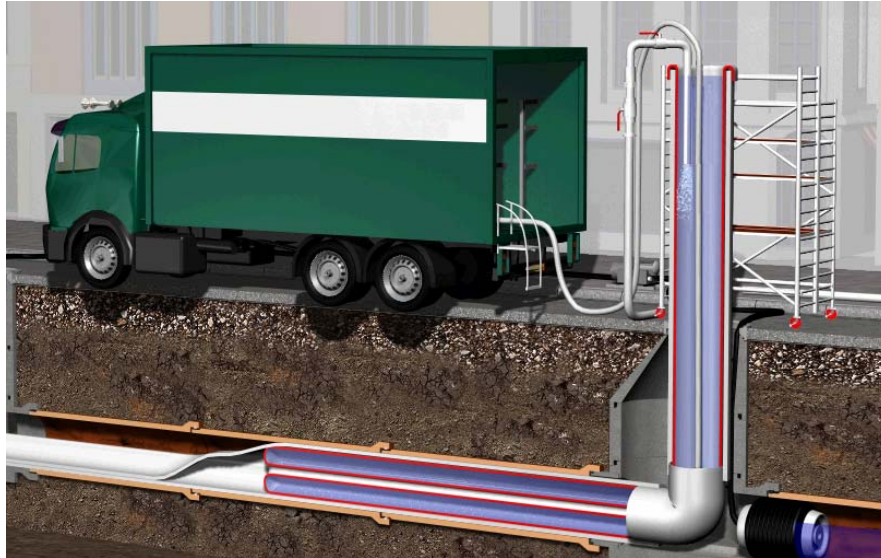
Einzug eines Inliners, schematisch dargestellt (Foto Dr. Stein)
